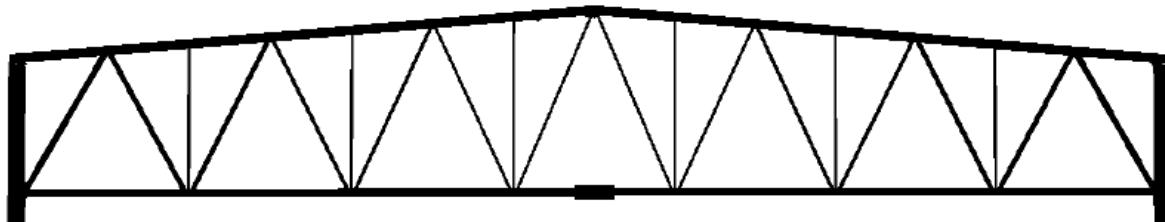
Configuration typique d'une poutre treillis avec une pente de toit de 1: 20 (~3°) [31]
